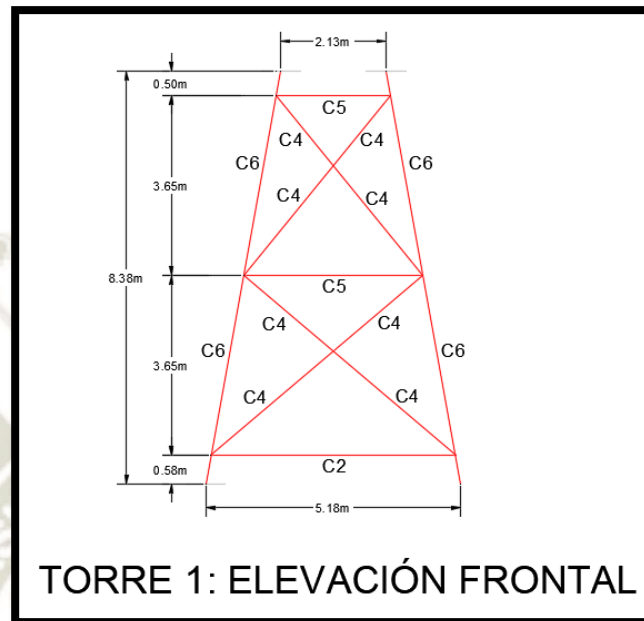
Esquema del Pilar 1 del Puente Sumbay
